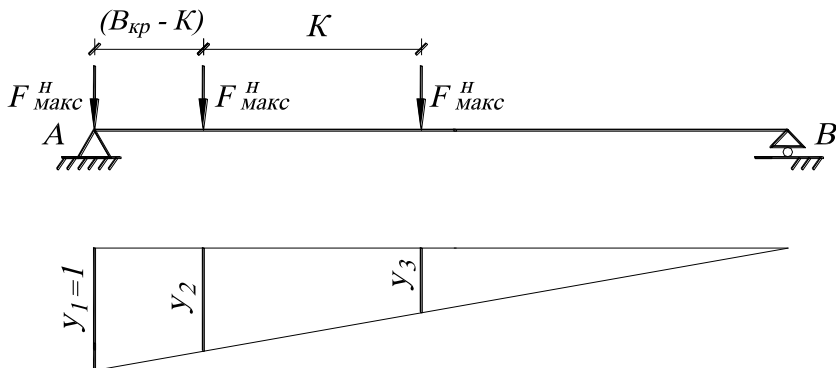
Схемы загрузки подкрановой балки вертикальной крановой нагрузкой:
